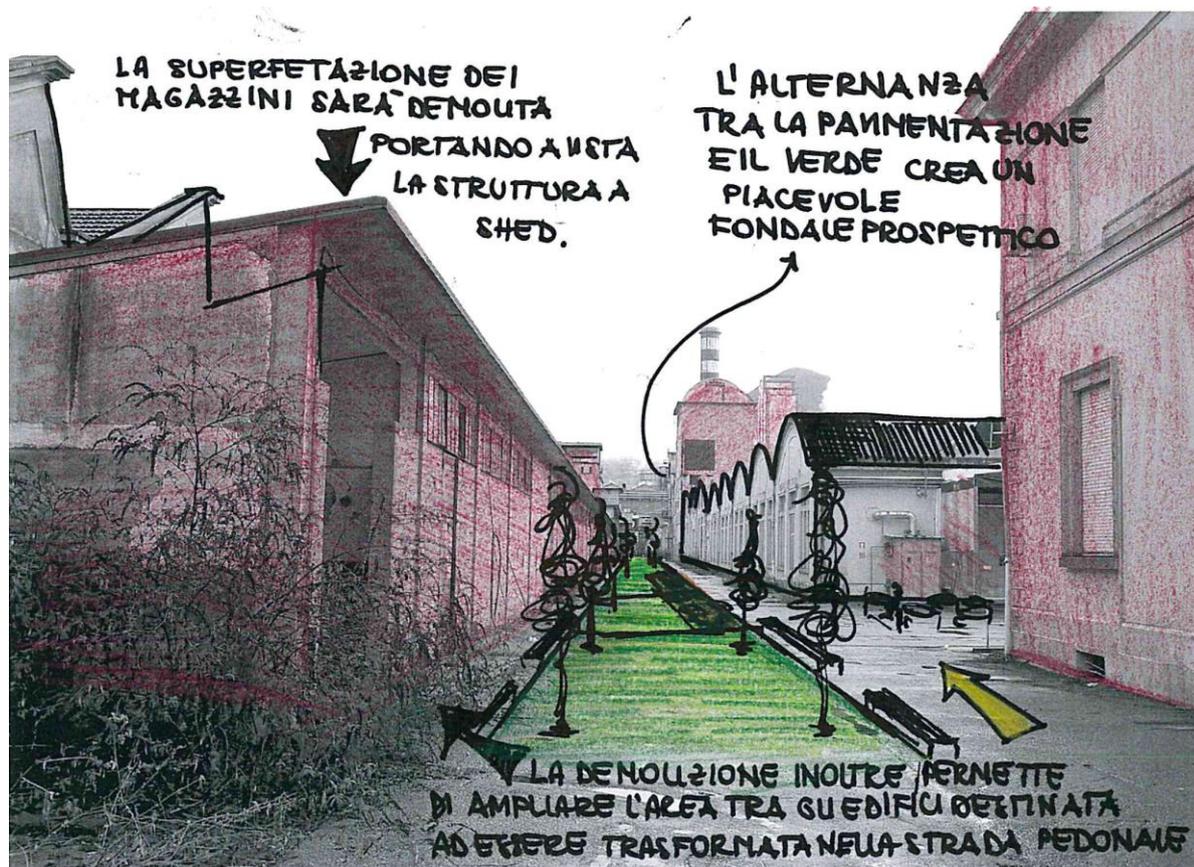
Vista prospettica sull'asse pedonale principale
